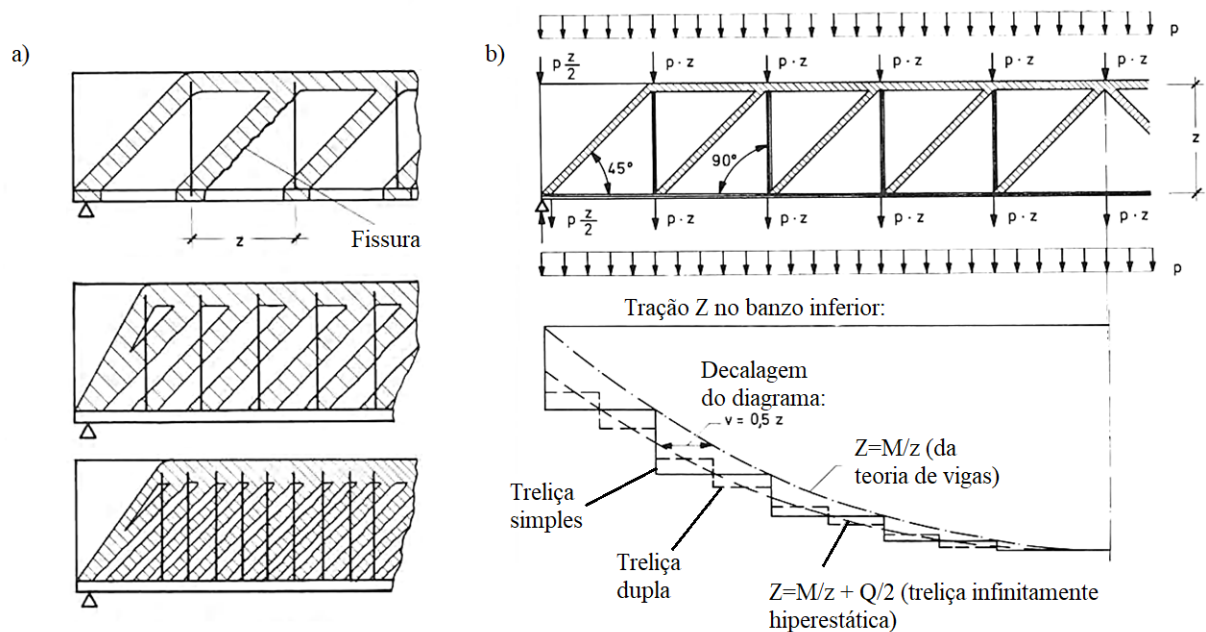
a) Padrão de fissuração para uma viga com armadura inclinada nos apoios
